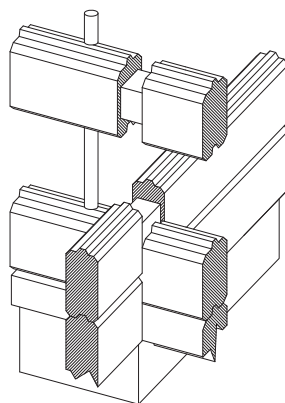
Particolare del giunto d'angolo fra due pareti e della sovrapposizione dei tronchi di una parete.
